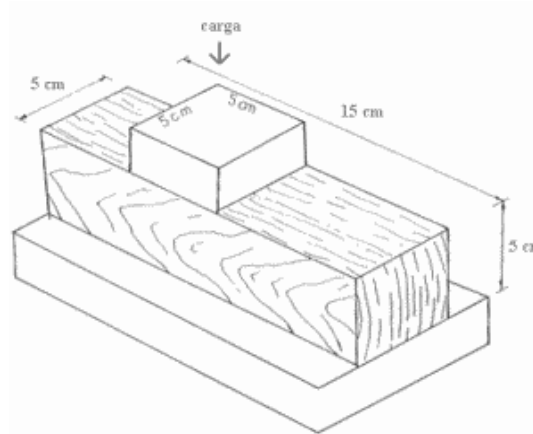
Probeta para ensayo de compresión perpendicular al grano
